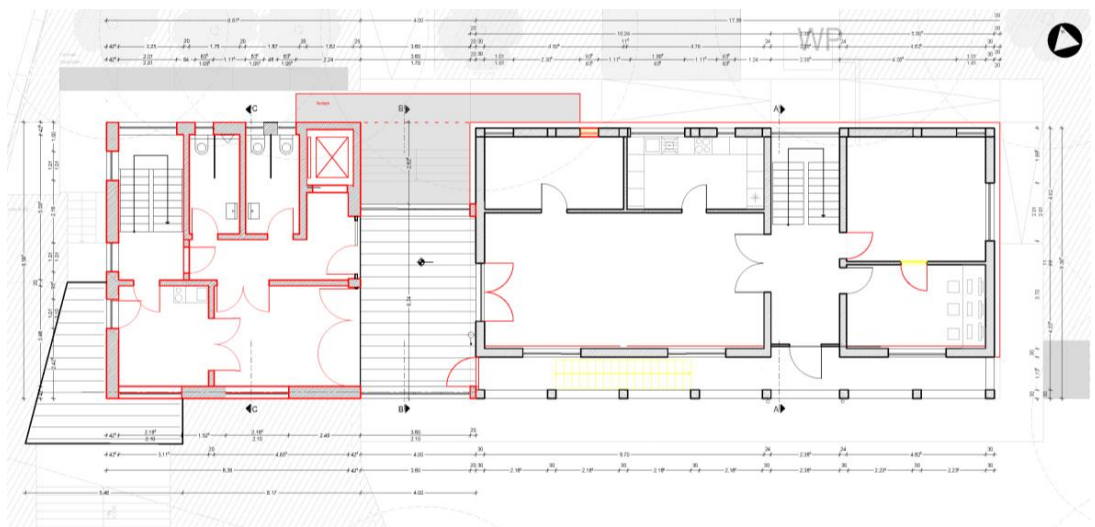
Grundriss Obergeschoss, Quelle: Rittmannsperger Architekten
